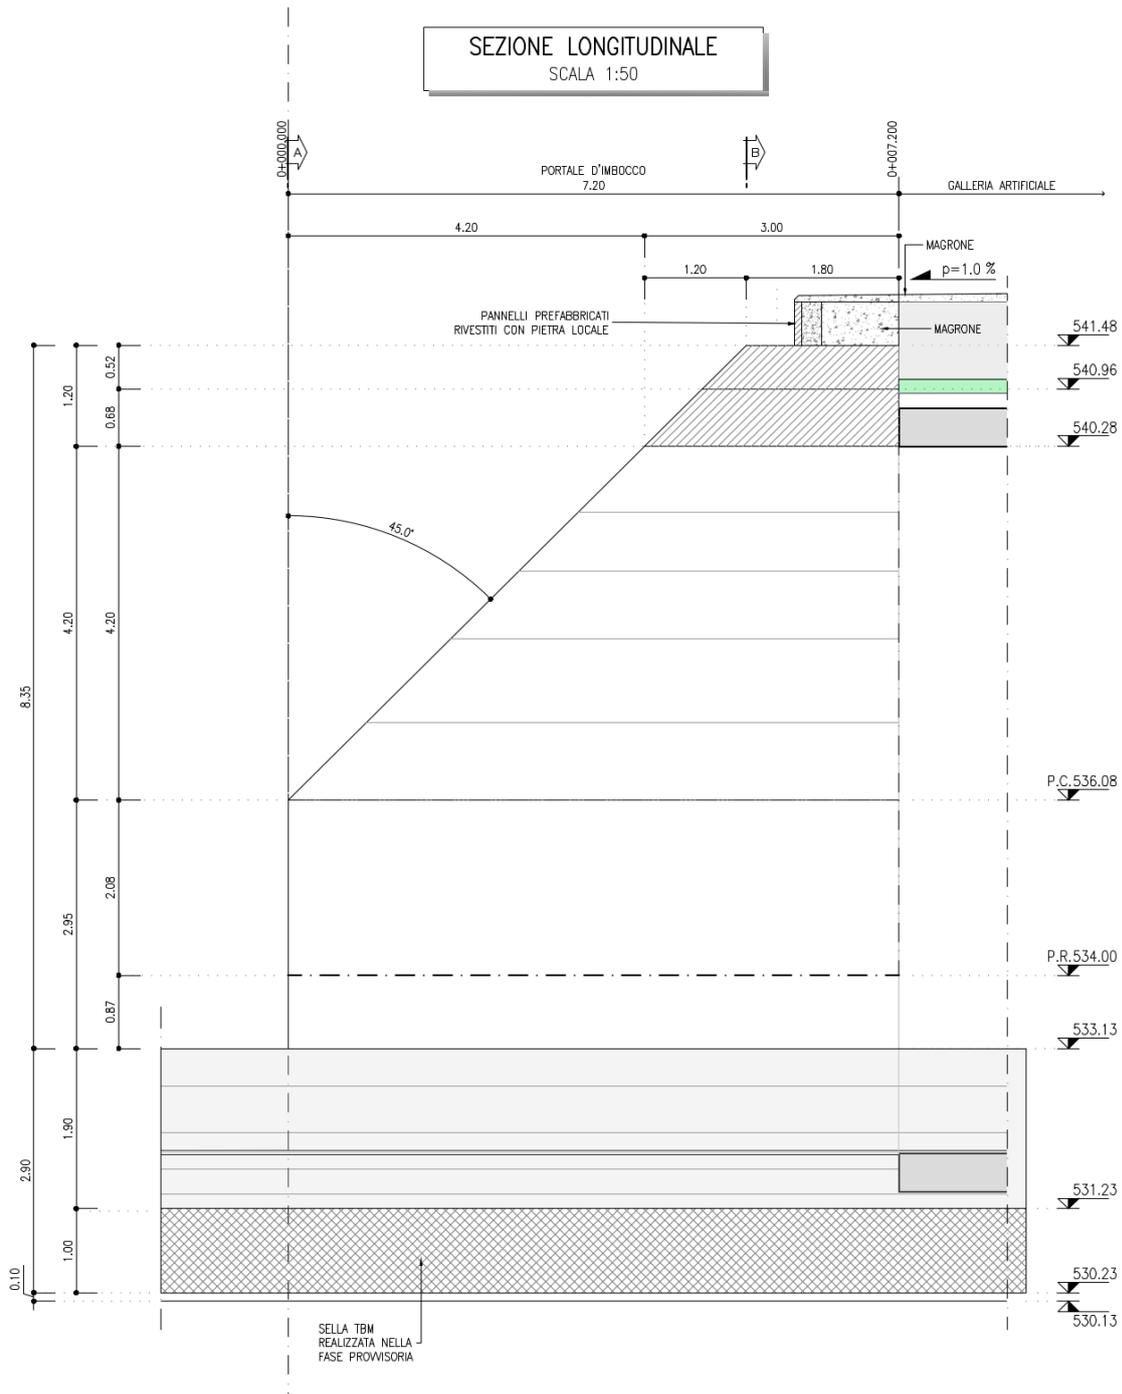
Sezione Longitudinale – Becco di Flauto
